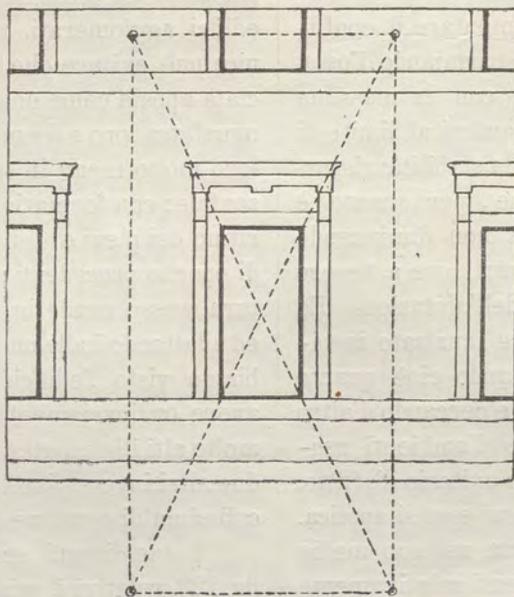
Proporzioni degli elementi di un prospetto moderno.
